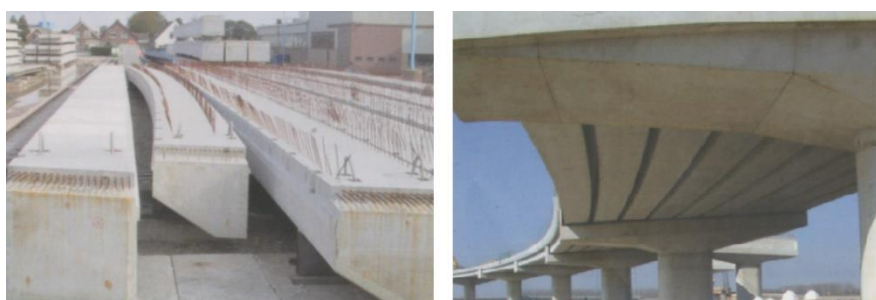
Vigas caixão curvas e exemplo de aplicação num viaduto, Spanbeton BV, Países Baixos (FIB, 2004)
